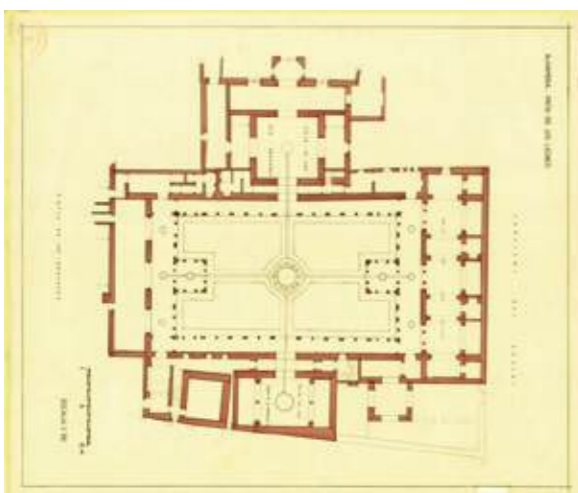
Planta del Palacio de los Leones (Archivo Junta de Andalucía)
